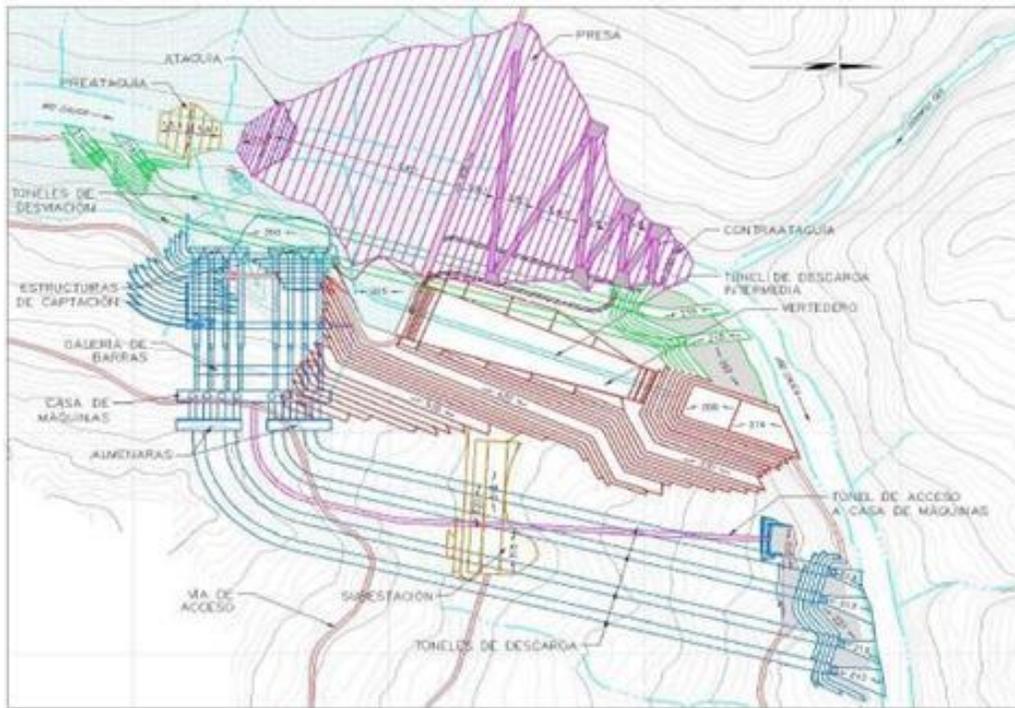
Vista en planta del conjunto de obras de la hidroeléctrica Ituango
